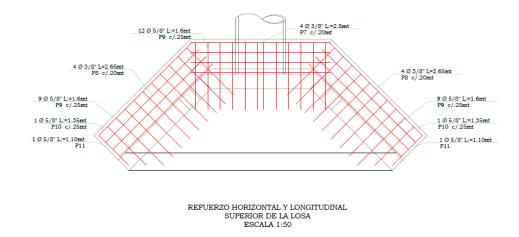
refuerzo horizontal y longitudinal superior de la losa.
